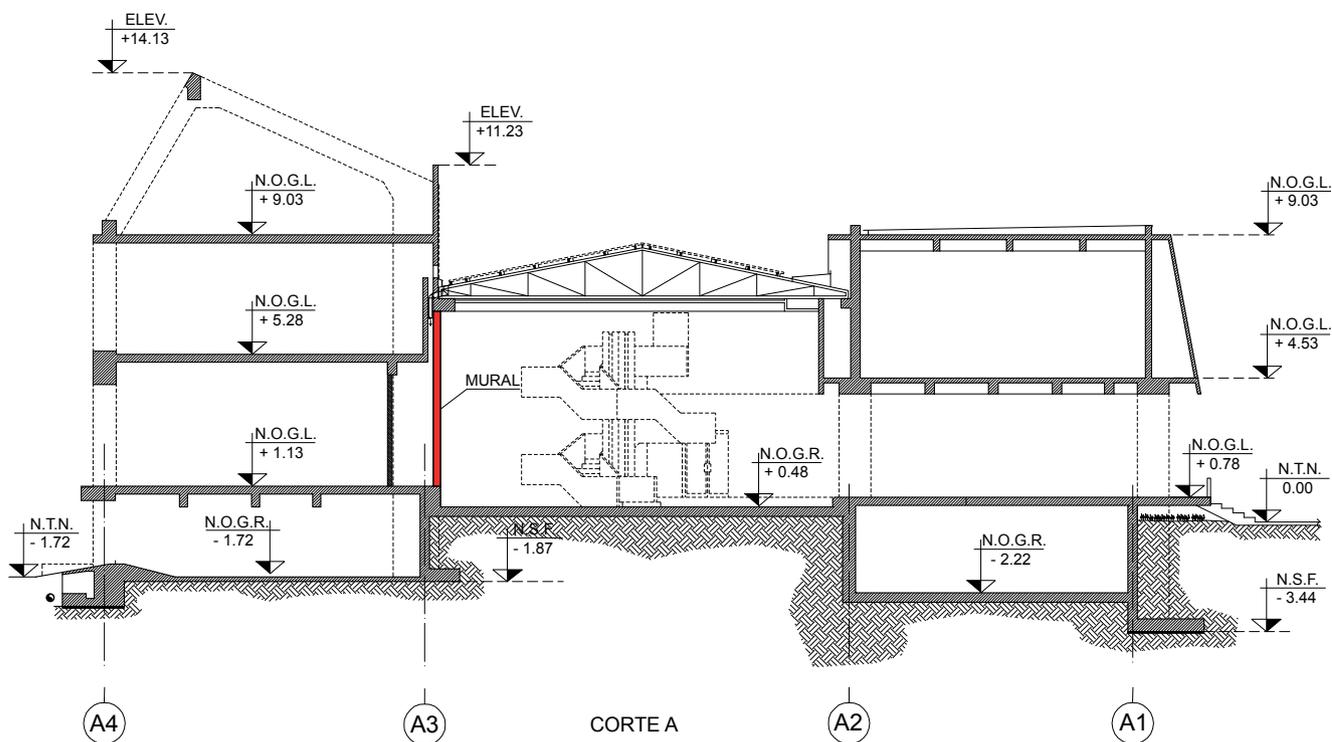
Corte arquitectónico en el que aparece la ubicación del mural y la armadura del techo que la cubre.
